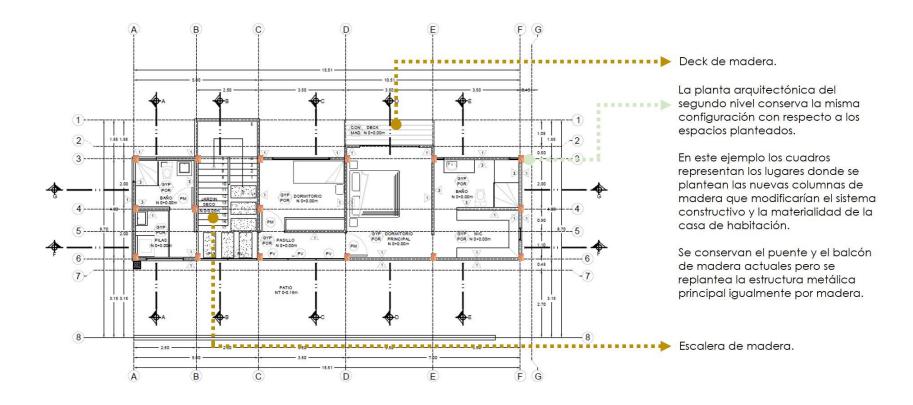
Planta Arquitectónica del segundo Nivel con modificaciones. Fuente: Elaboración personal, 2020.
